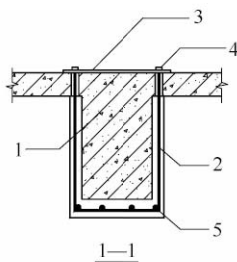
框架梁端斜裂缝钢筋混凝土套修复加固方法
